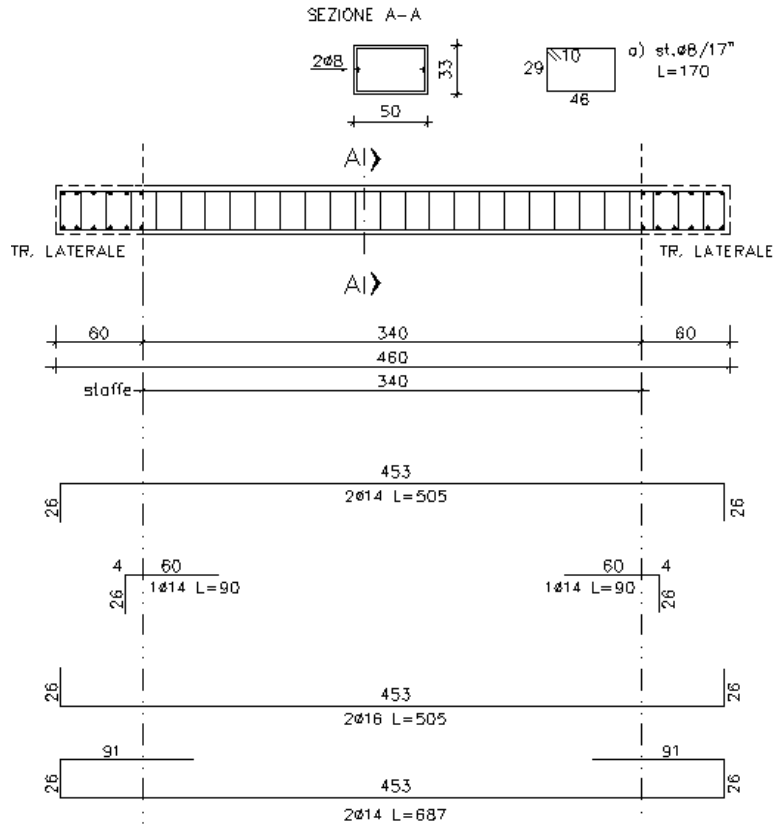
Ex-Lavanderie: carpenterie ed armature trave "scala"
